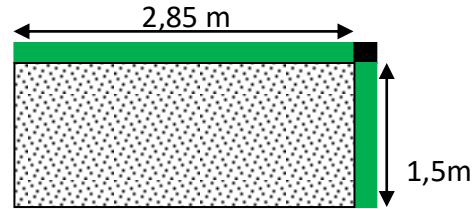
schéma d'une dalle pleine sur 2 appuis.
